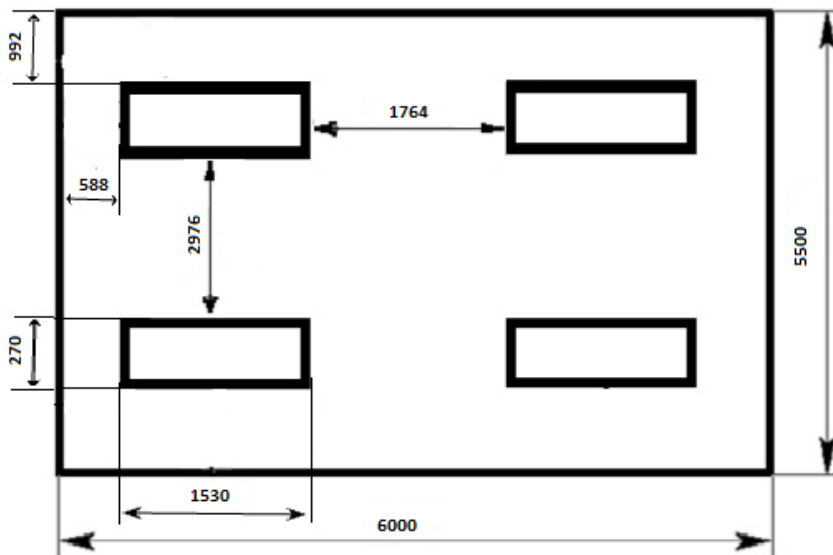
План помещения и размещения светильников с люминесцентными лампами
